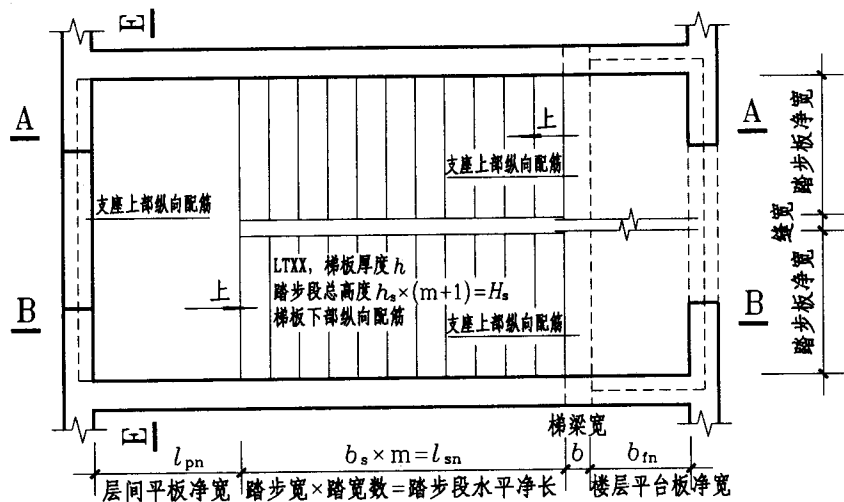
注写方式 标高XXX—标高XXX楼梯平面图
